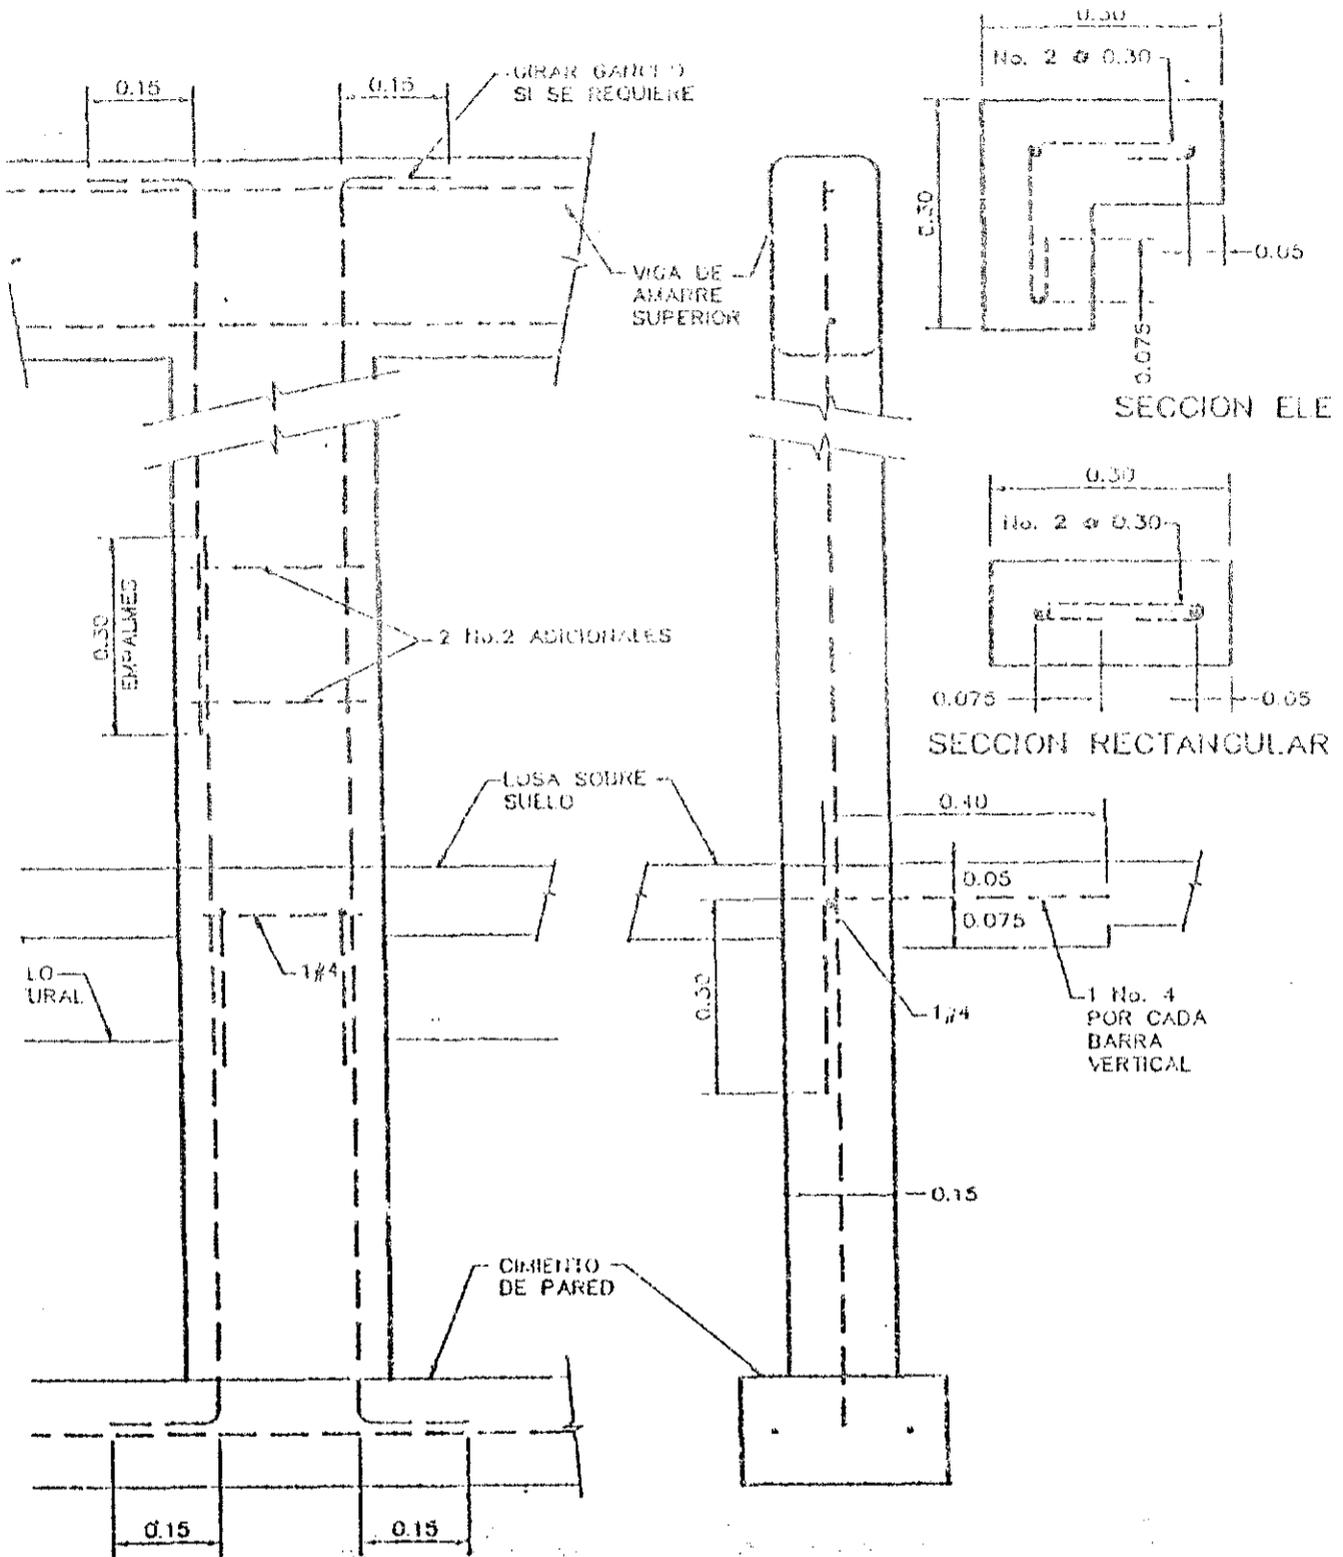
DETALLES TÍPICOS DE COLUMNAS DE AMARRE
